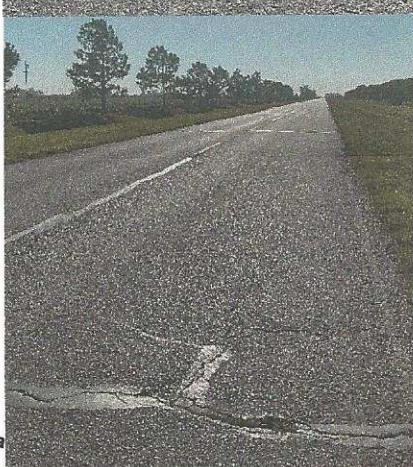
Longitudinalmente desprendimientos y fisuras en el pavimento.
